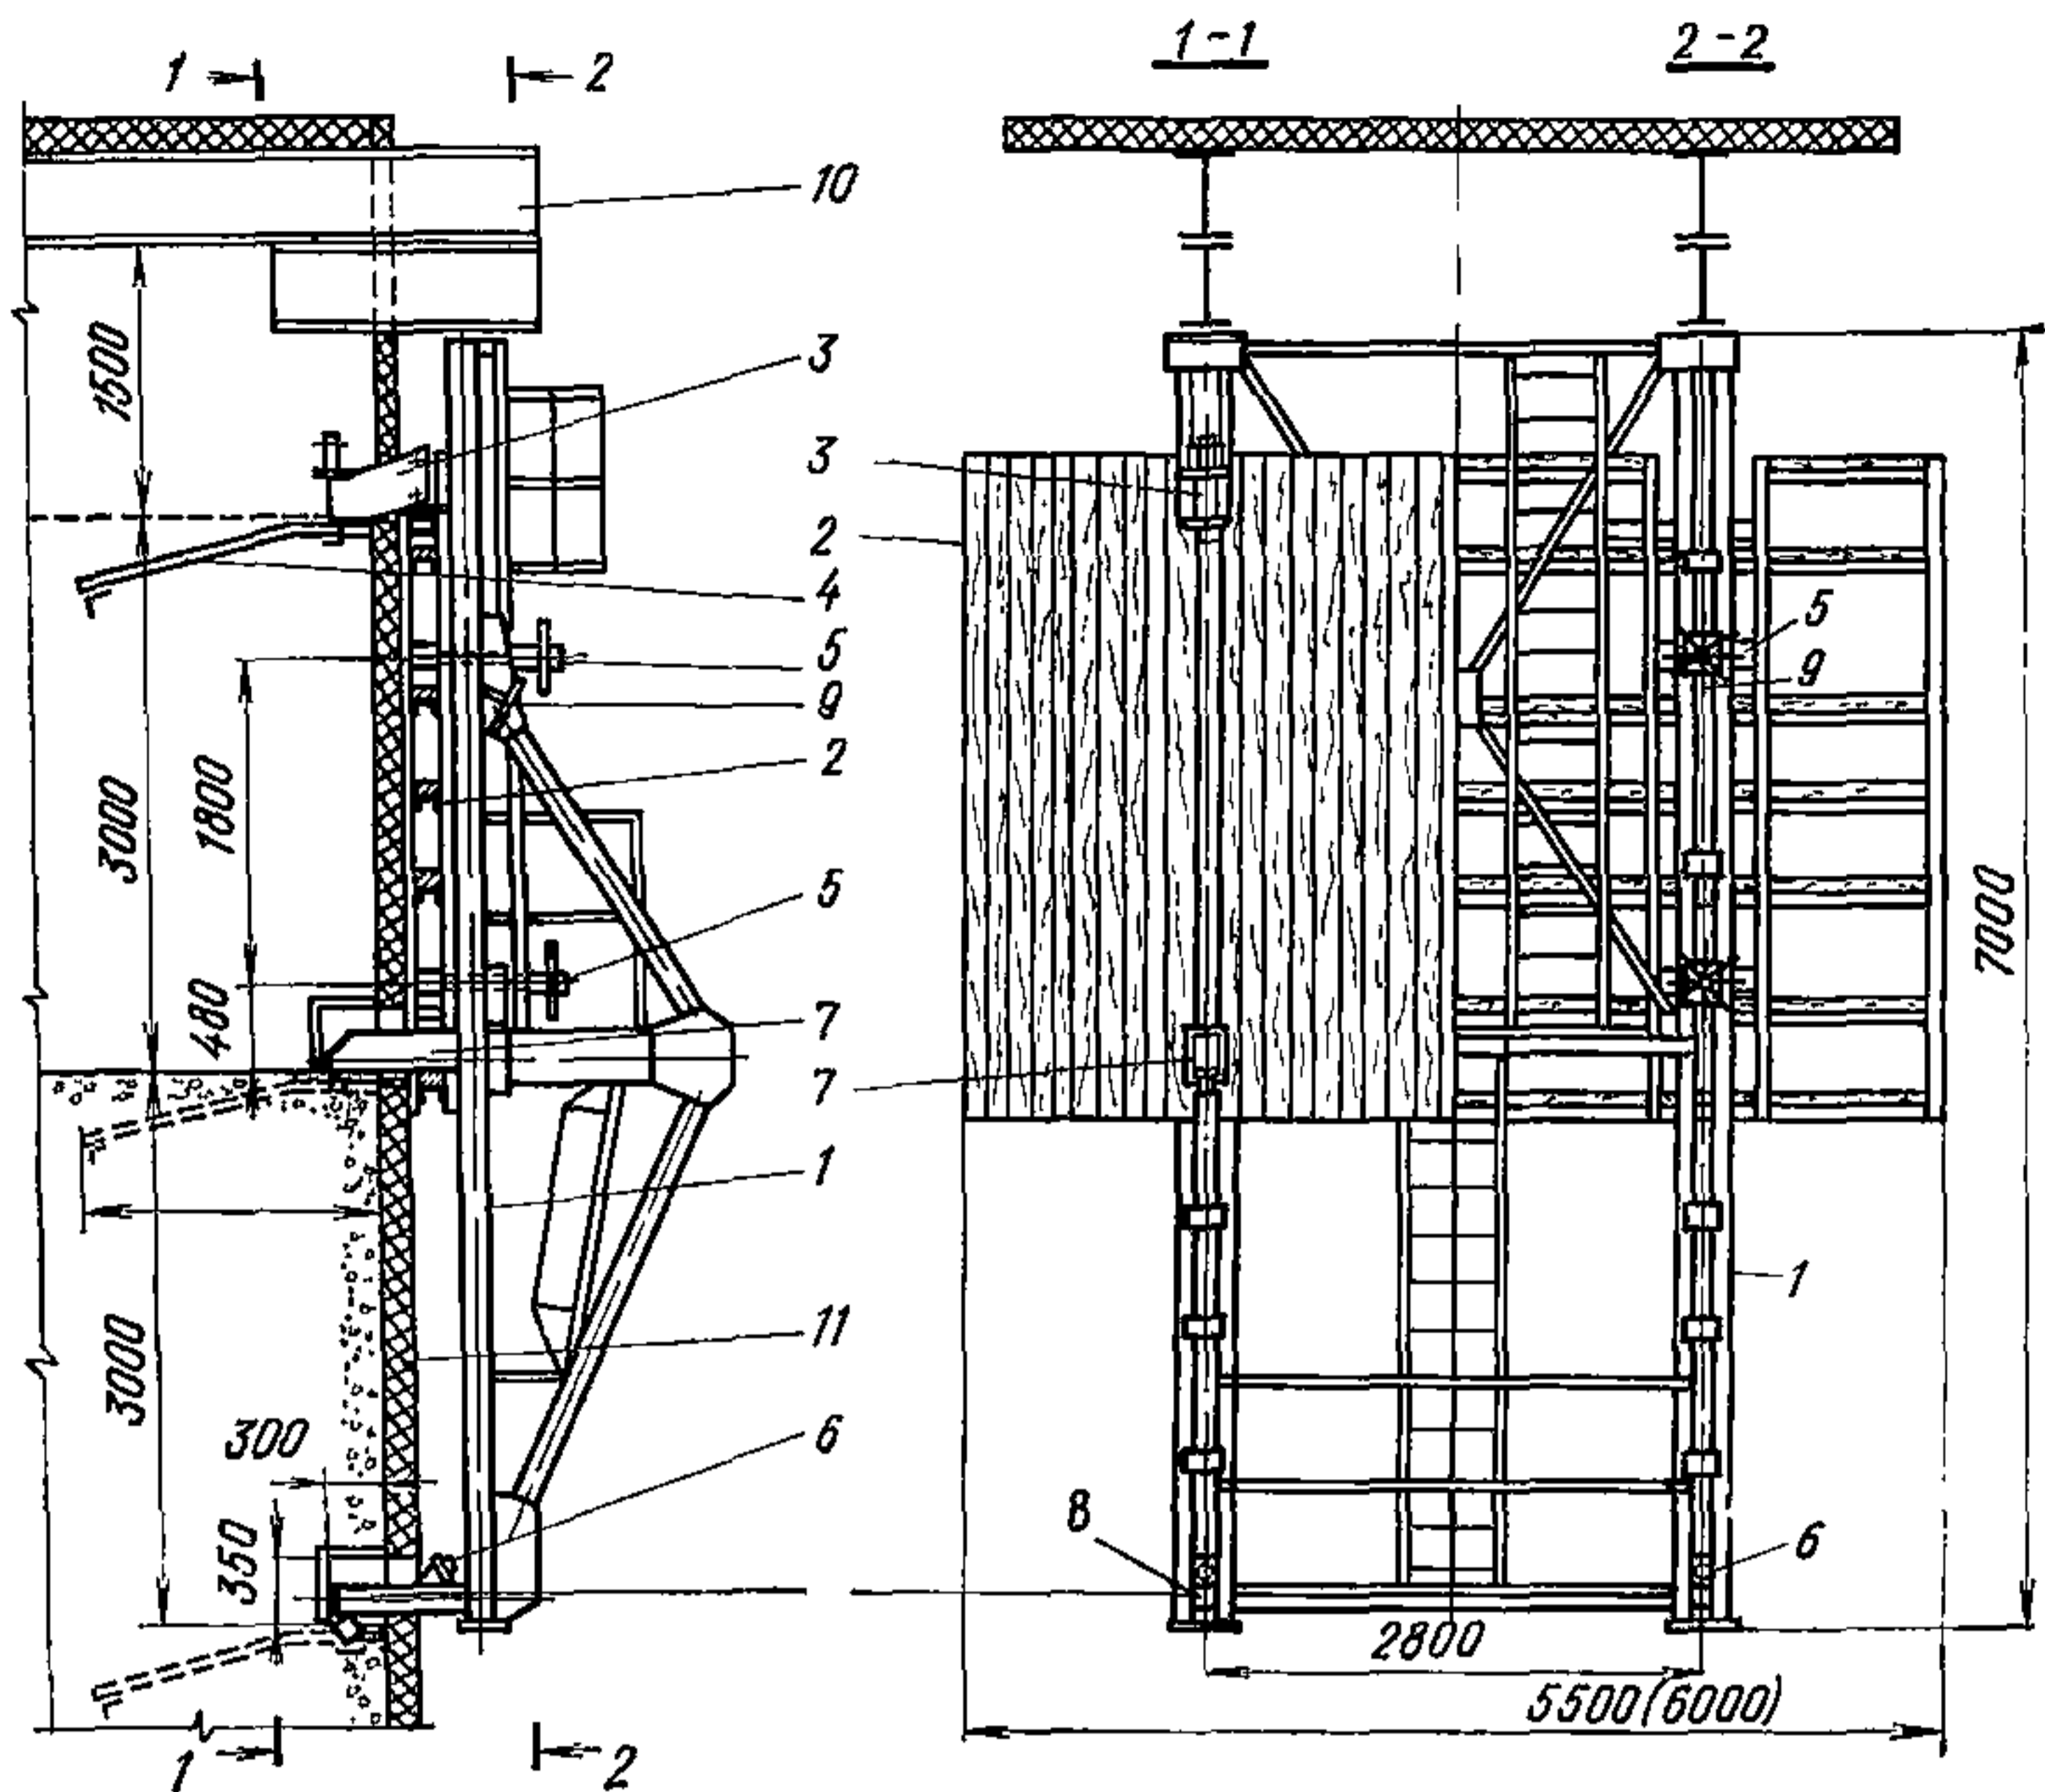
Универсальная консольная опалубка УК-18 (бетон, щит-утеплитель и анкеры на 1-1 не показаны)
